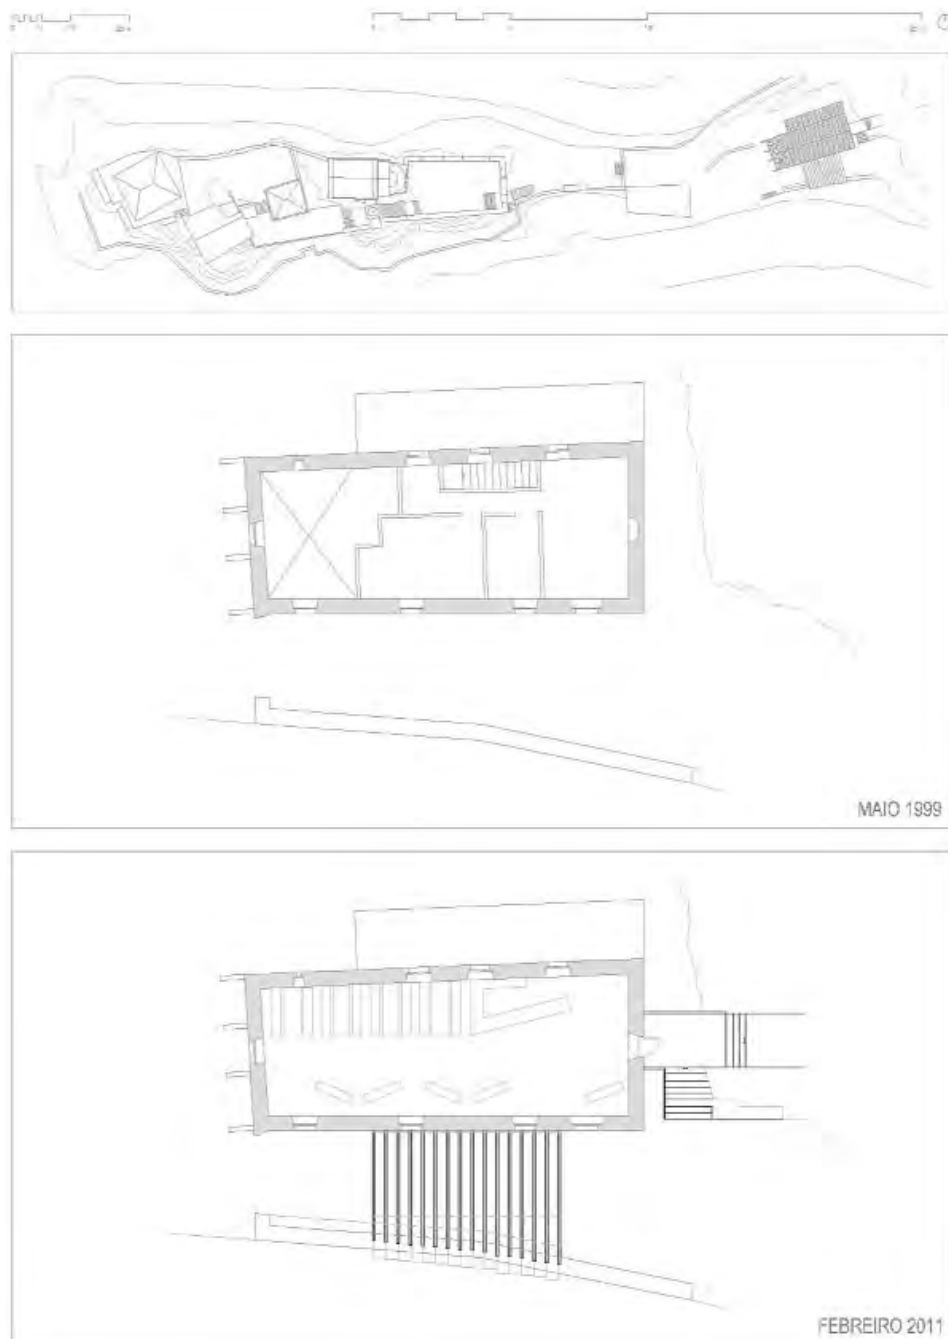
CAAVEIRO. Planta alta da Casa dos Guardeses (Pavillón de servizos e aula).
